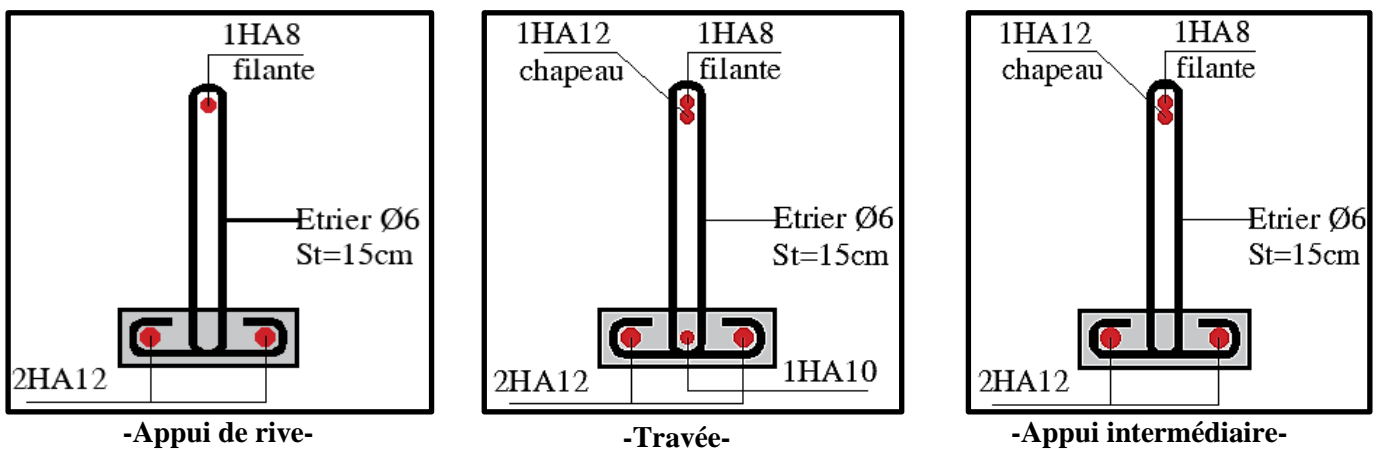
Ferrailages des poutrelles (étage courant et terrasse accessible)
